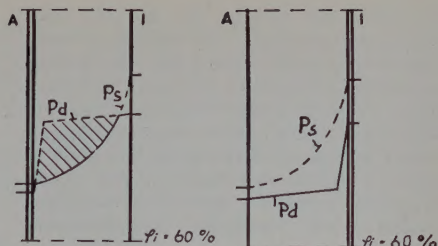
Einfluß des Wasserdampfdruck-Gefälles und Wirkung einer außen angebrachten Wasserdampfsperre bei einer Außenwand
